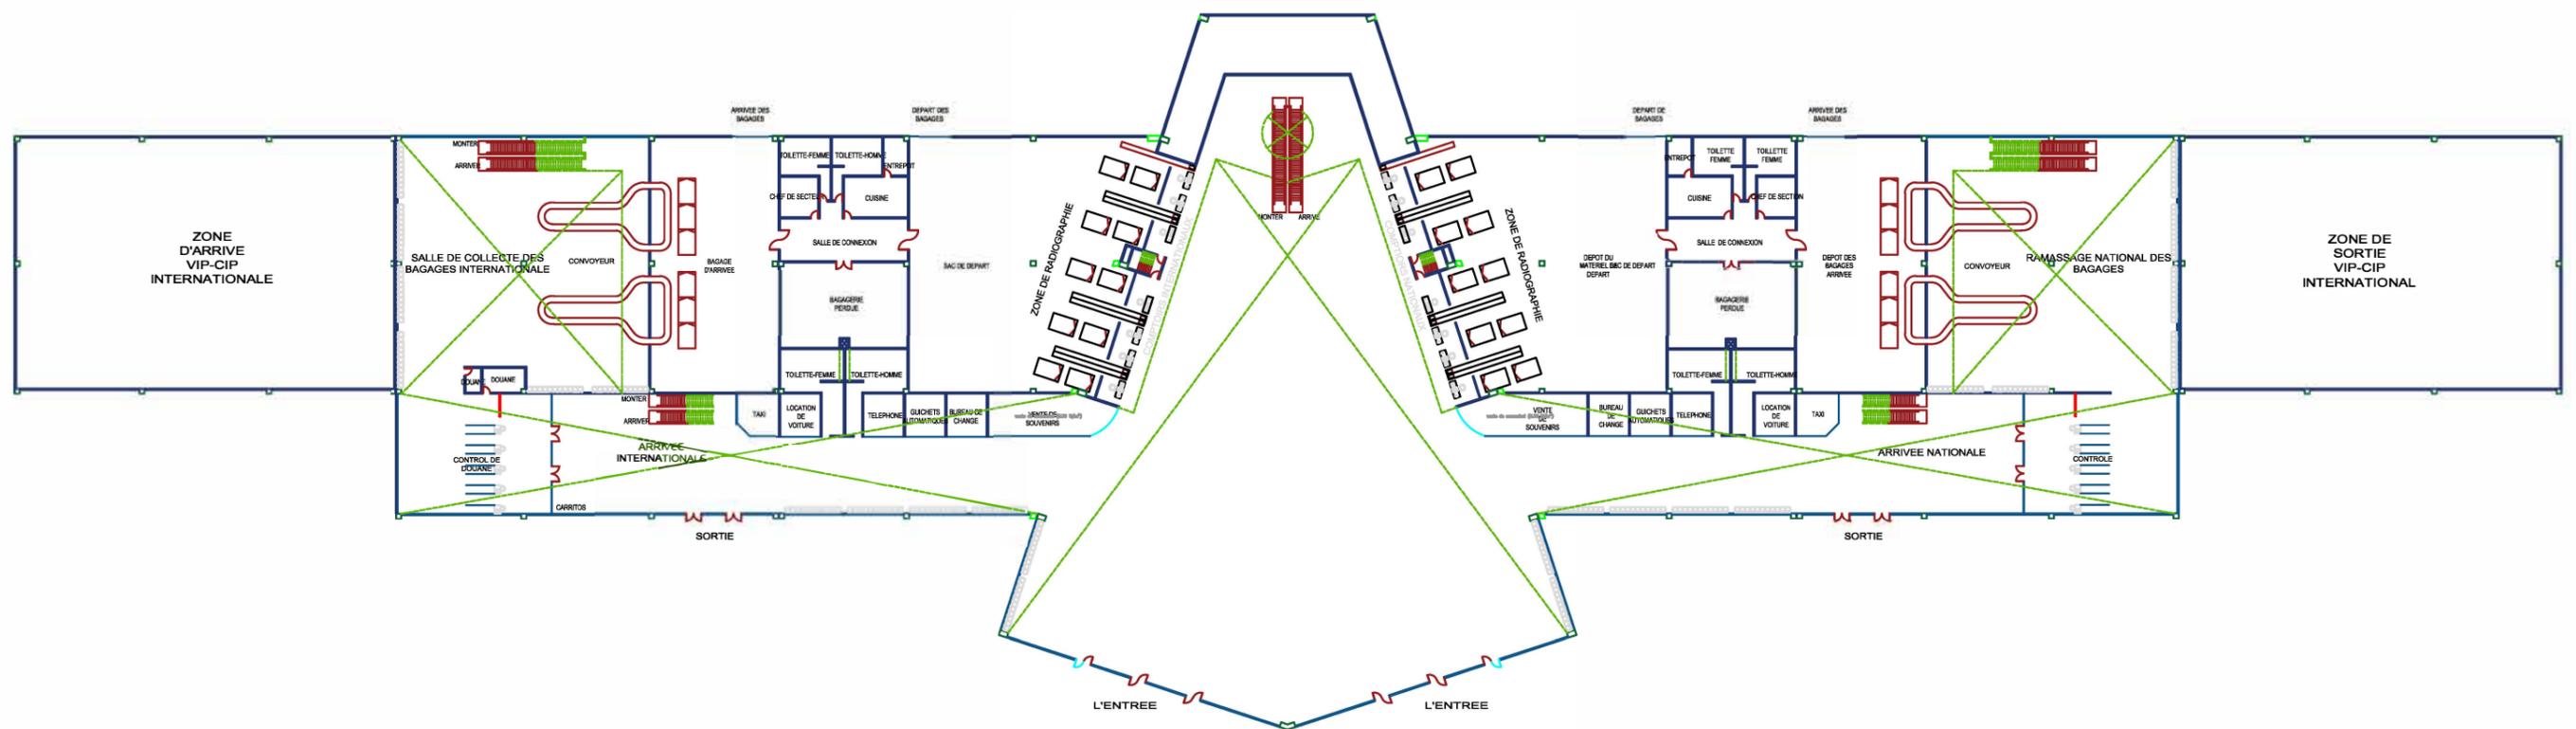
Plan d'architecture du rez-de-chaussée.
